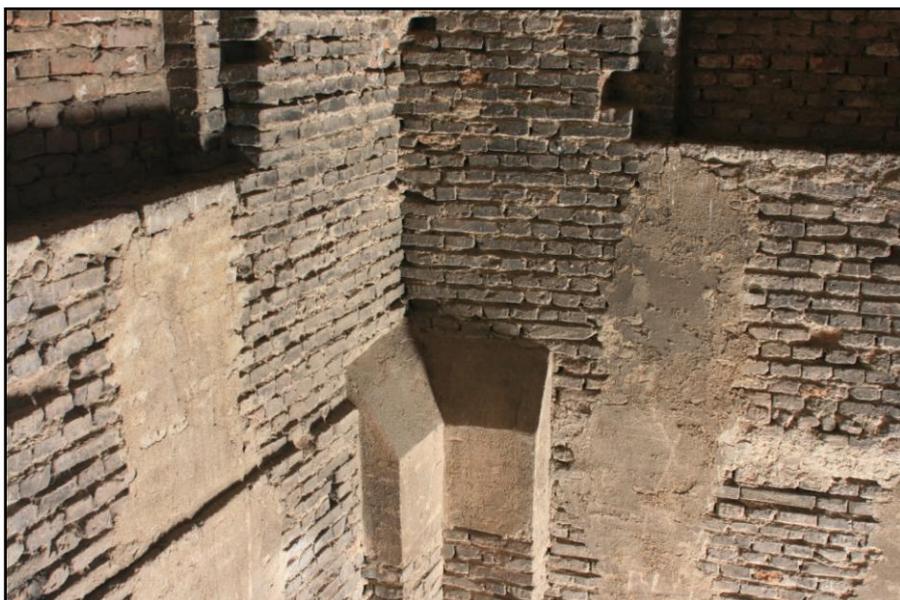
Rimaneggiamento sulla muratura all'altezza della terminazione del pliastrino
